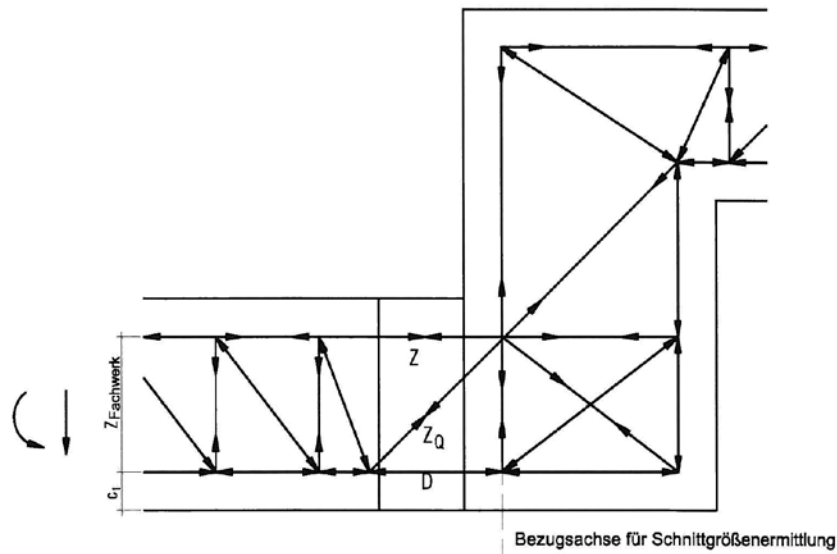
Schöck Isokorb Typ K mit Betondrucklager (Variante Höhenversatz)
